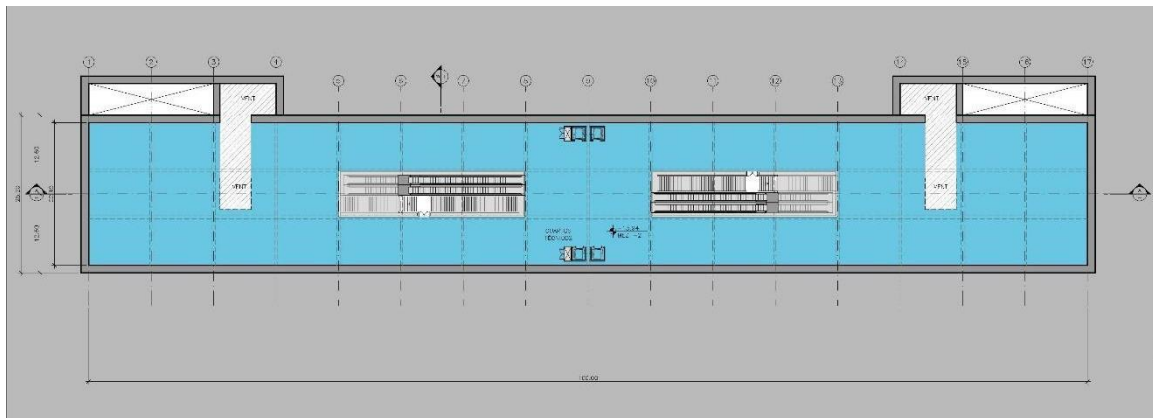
Planta Nivel Intermedio -2 (-13,94)
